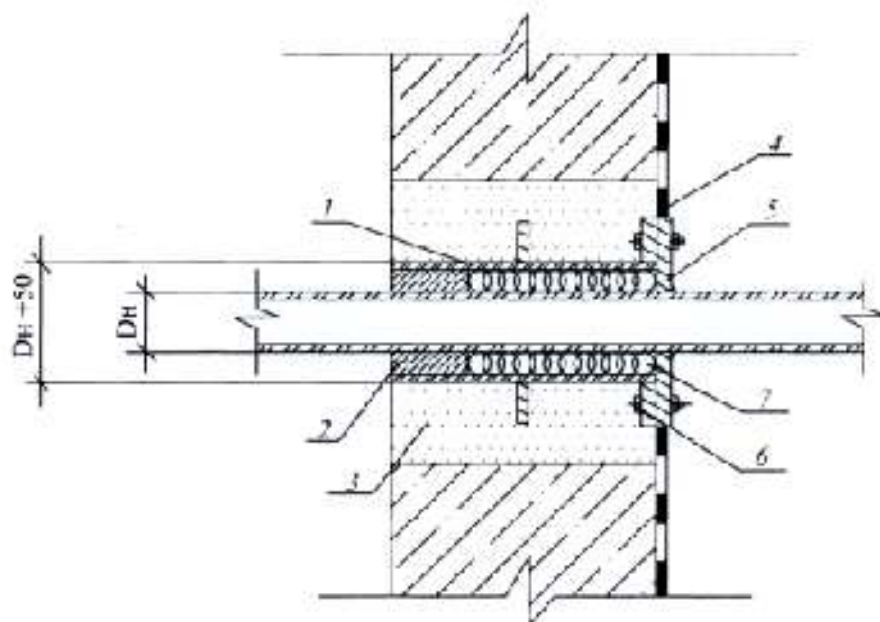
Конструктивное решение по устройству гидроизоляции фундаментов из ФБС-блоков при новом строительстве
